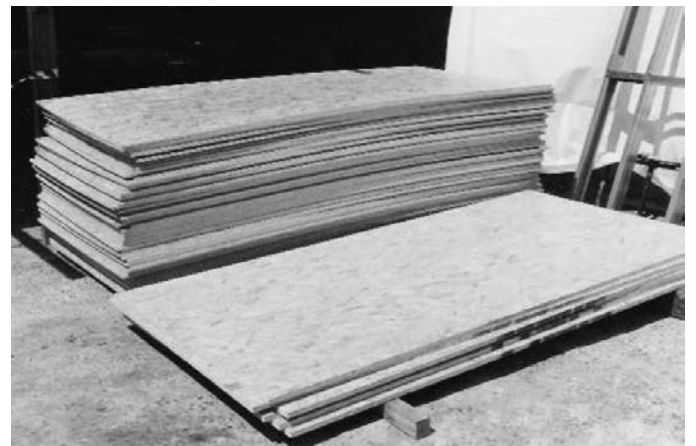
Placas de OSB. (Fuente: Archivo del autor)
